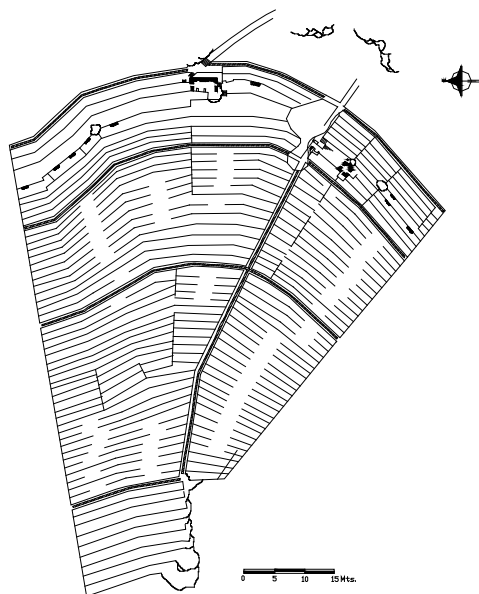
Plano del sector XII (Fuente Plan COPESCO 2004)
